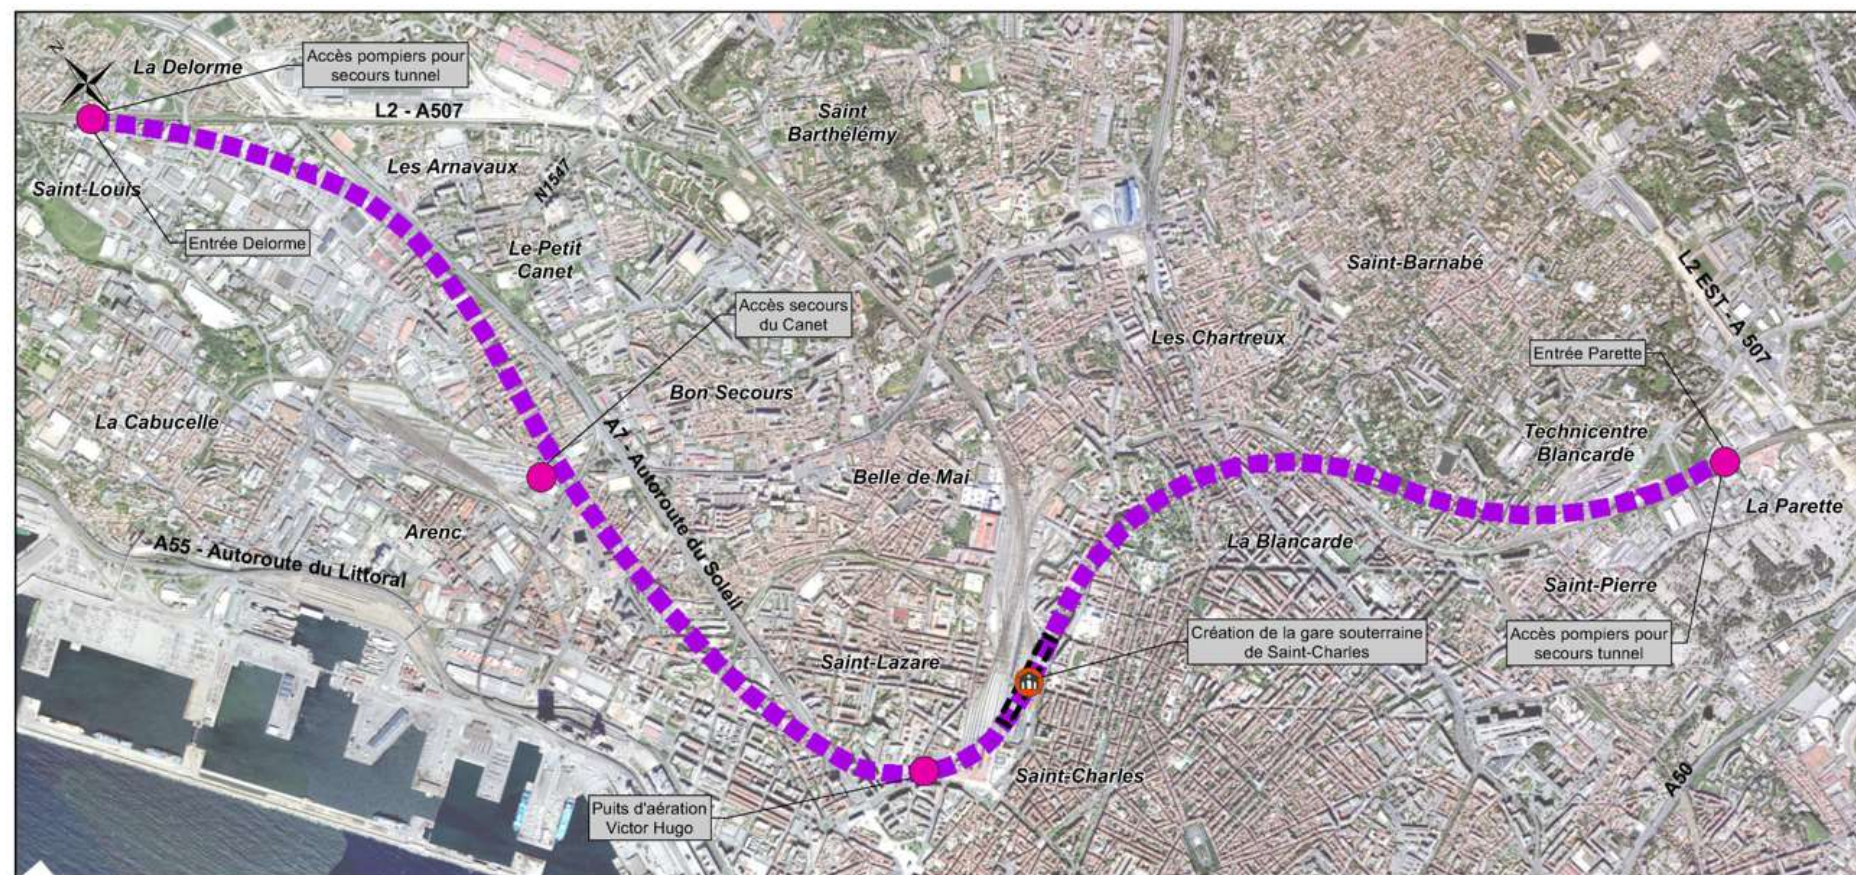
traversée souterraine de Marseille (Plan général des travaux, 2021)
